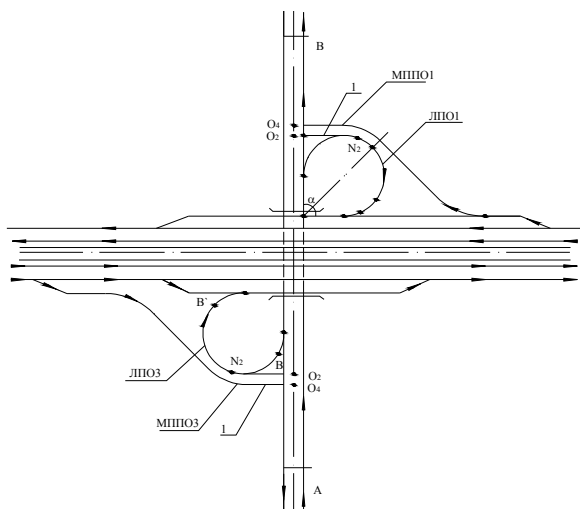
Схема транспортної розв'язки «неповний лист конюшини» з двома ЛПО
